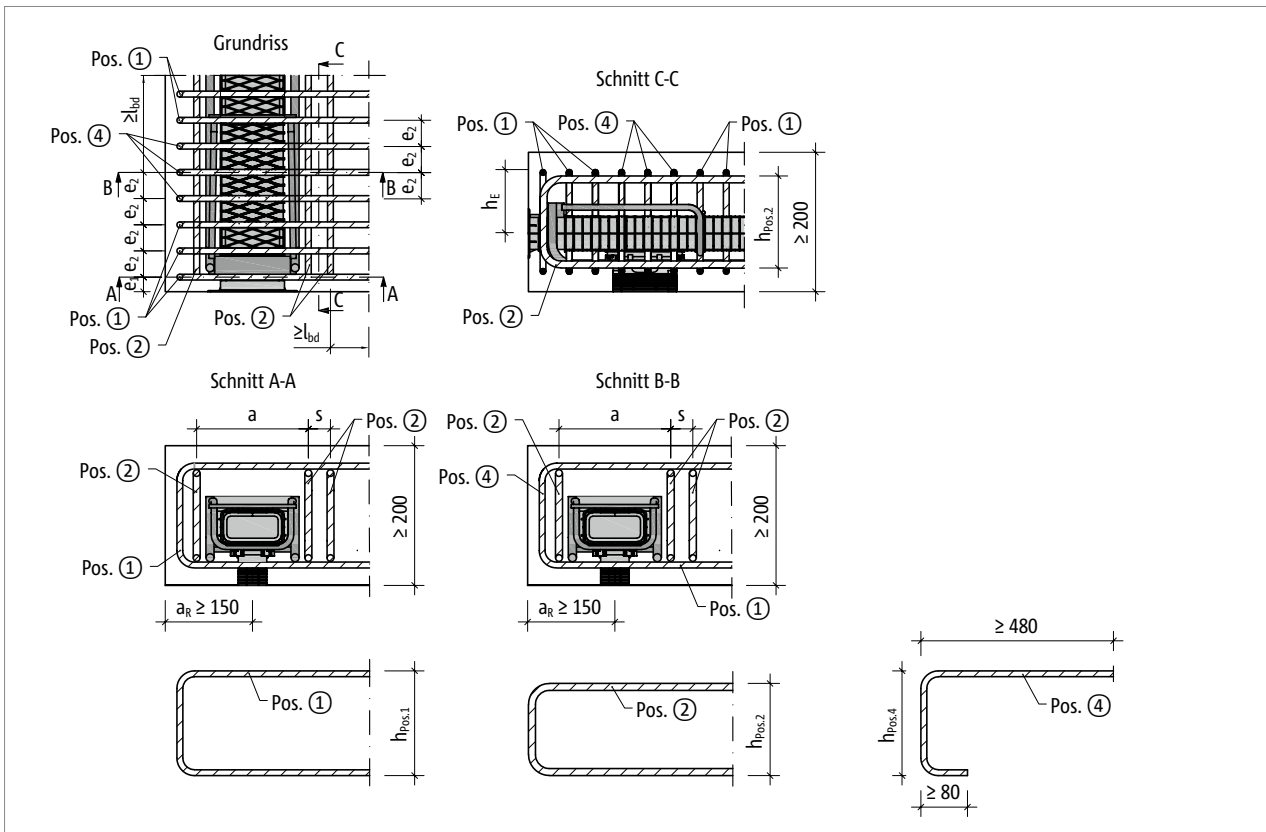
Tronsole® M-U: Bauseitige Bewehrung
